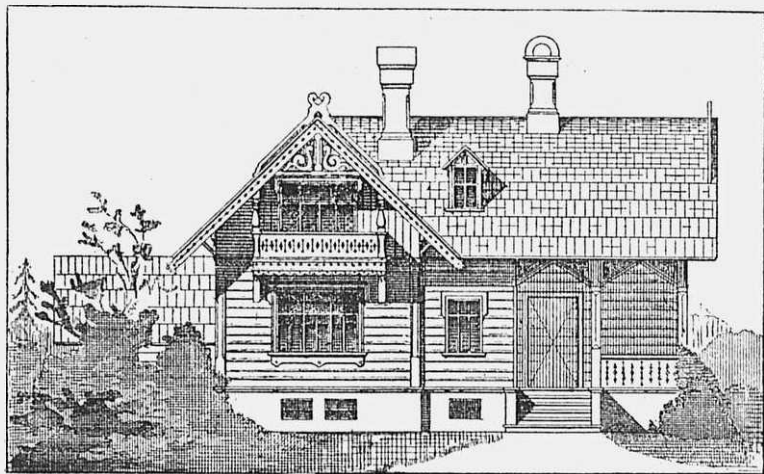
Фасадъ дома малой усадьбы на 98 кв. саженьяхъ.
